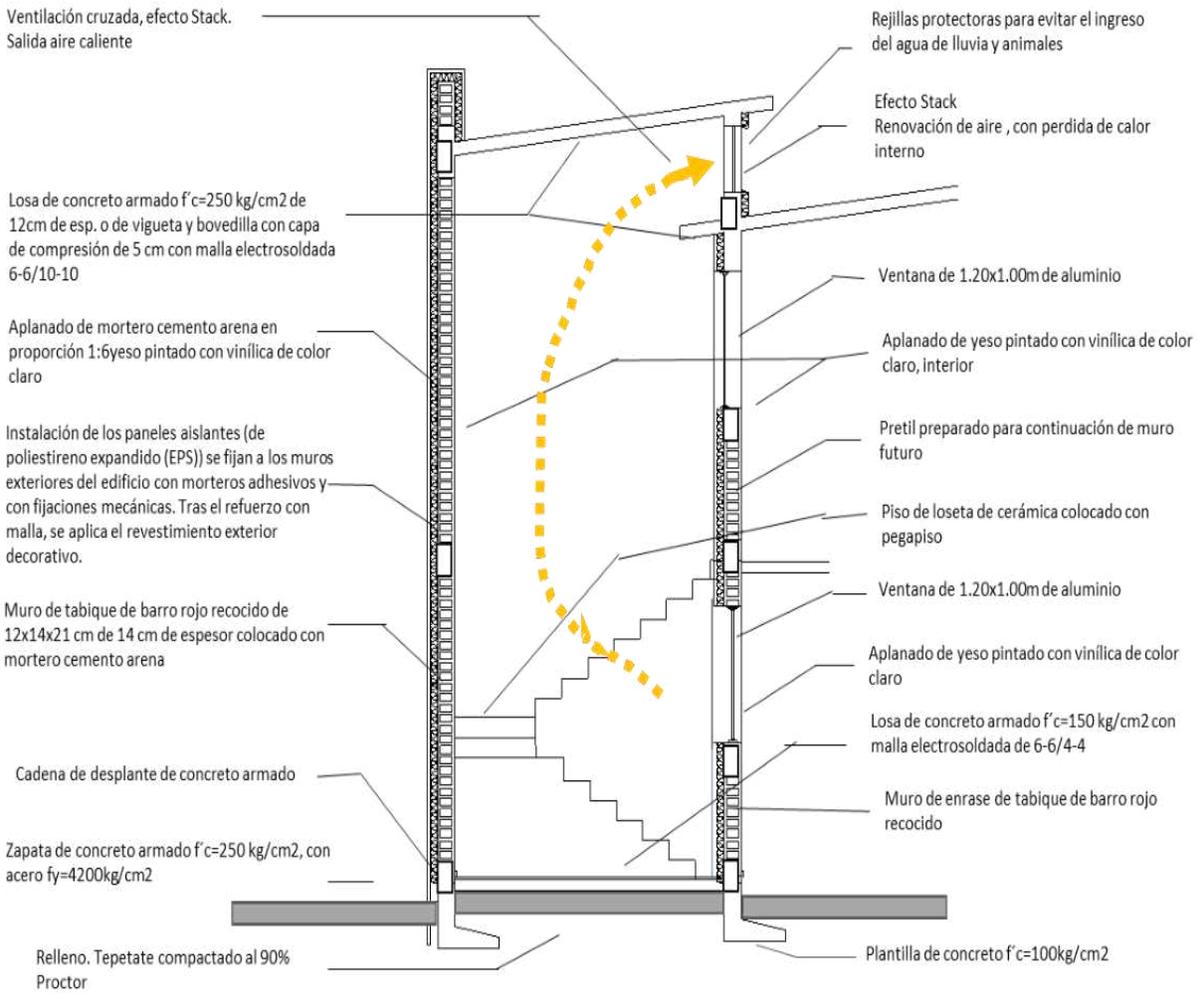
Corte por fachada de detalle constructivos a considerar en la propuesta de progresividad
